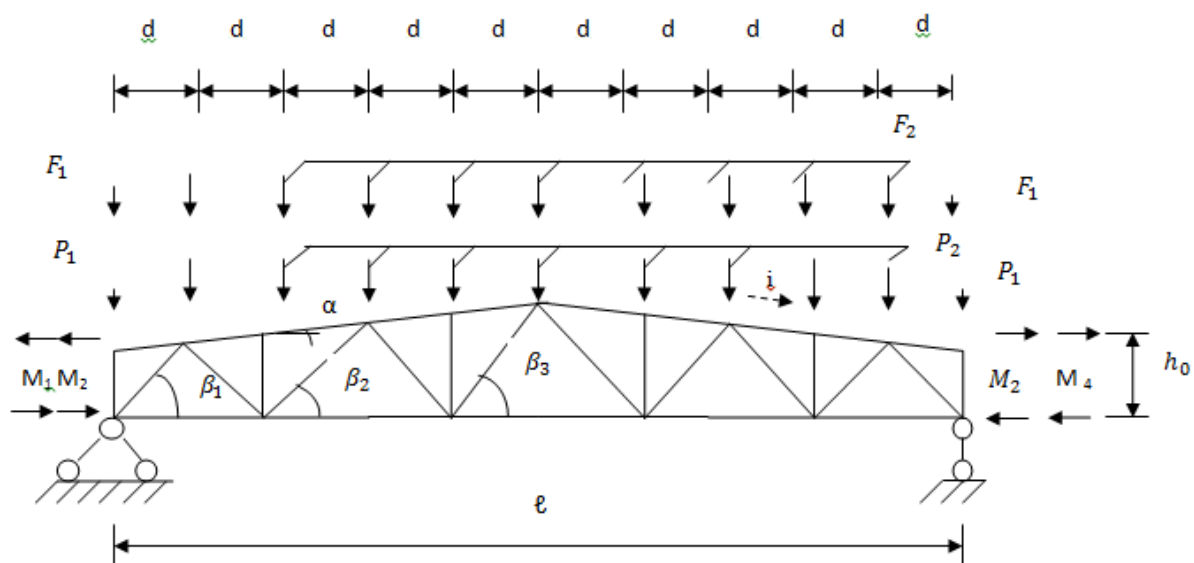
Геометрическая схема фермы –  $10d$ . Схема вертикальных нагрузок и опорных моментов действующих на узлы фермы
